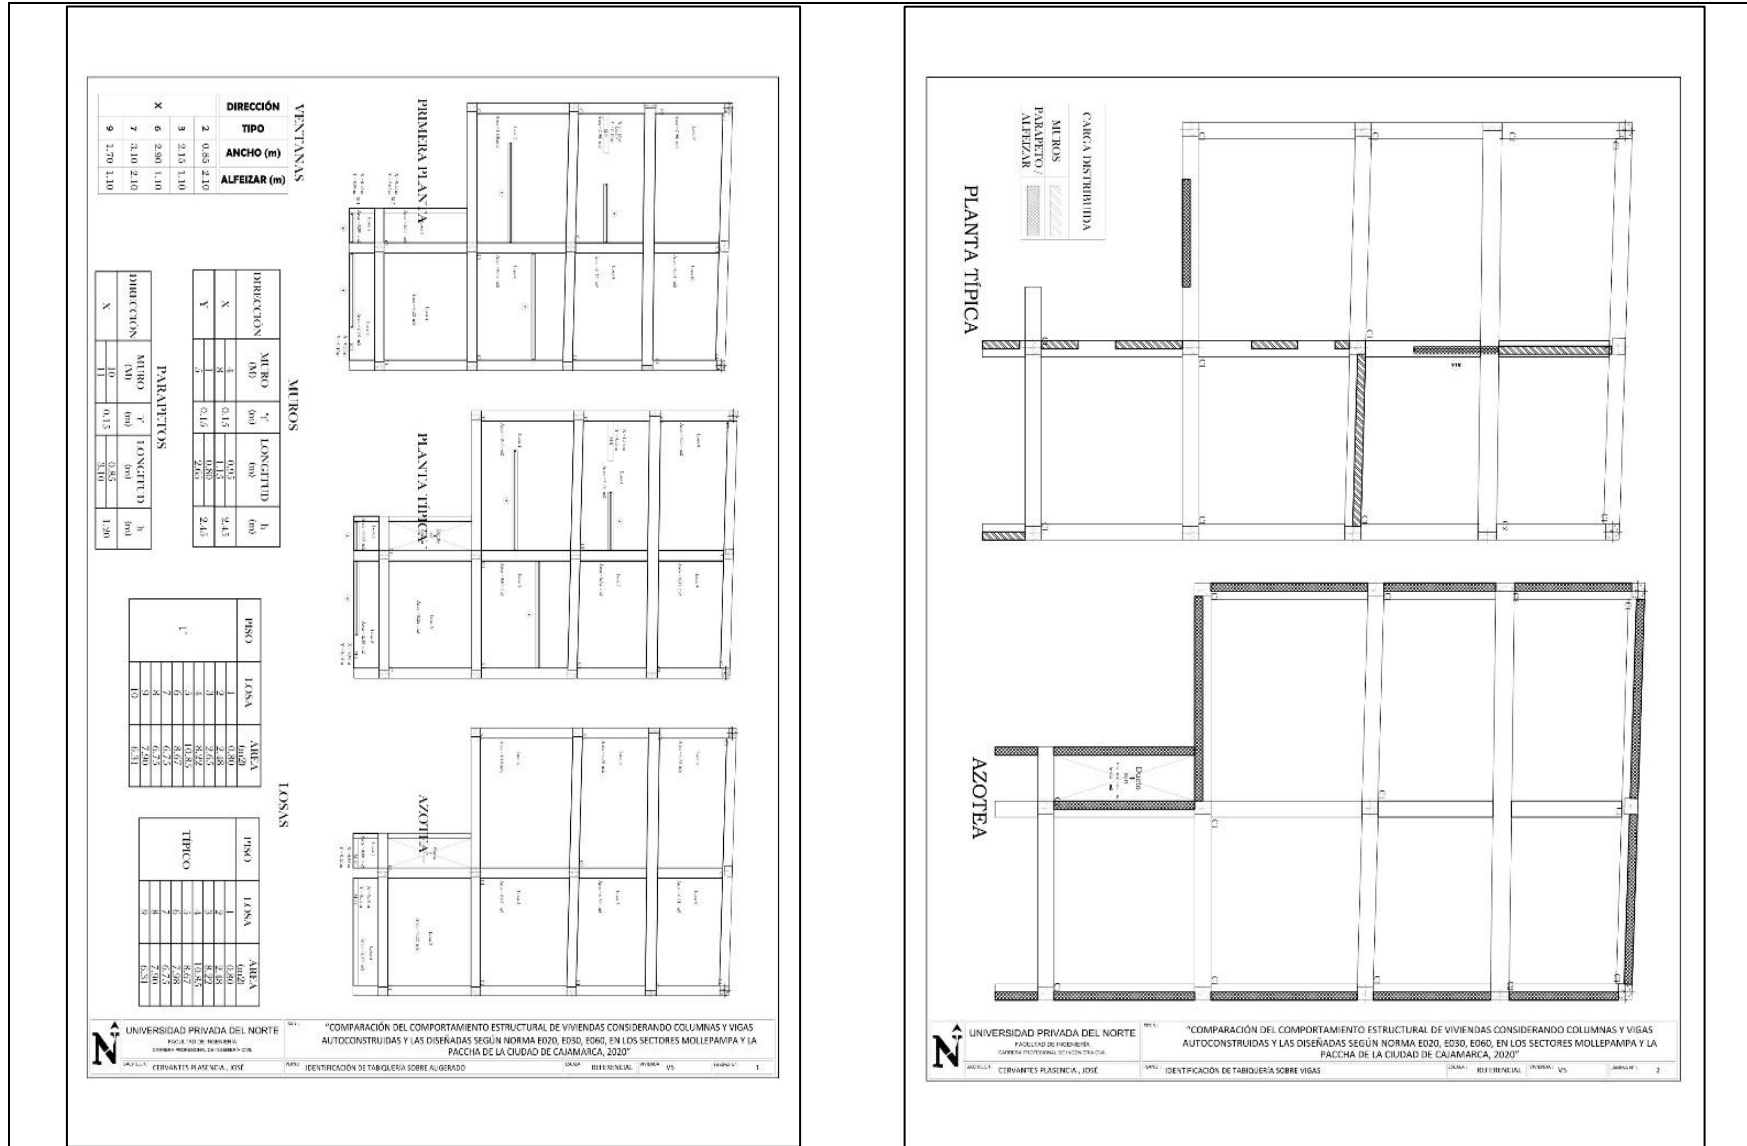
Tabiquería sobre losa aligerada y vigas vivienda 5
